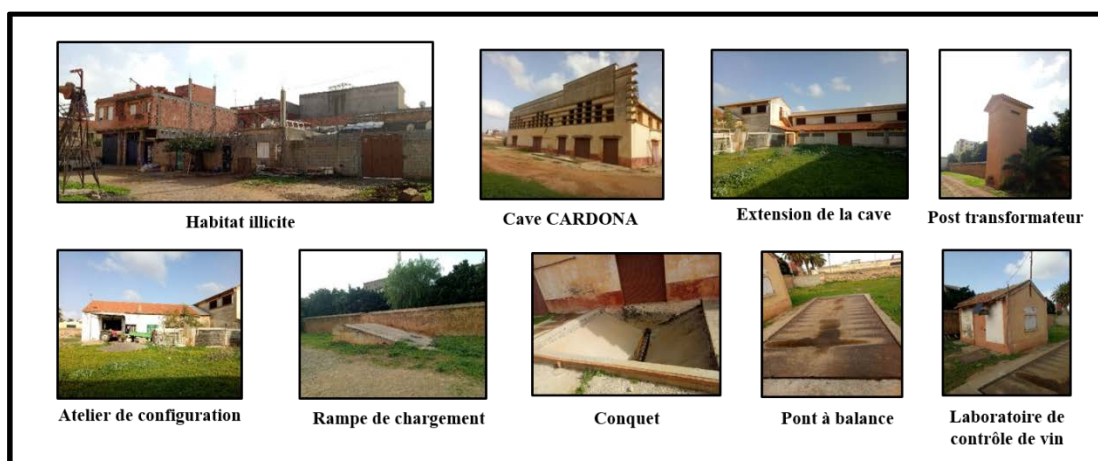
Structures existantes sur le site d'intervention¹⁶³
